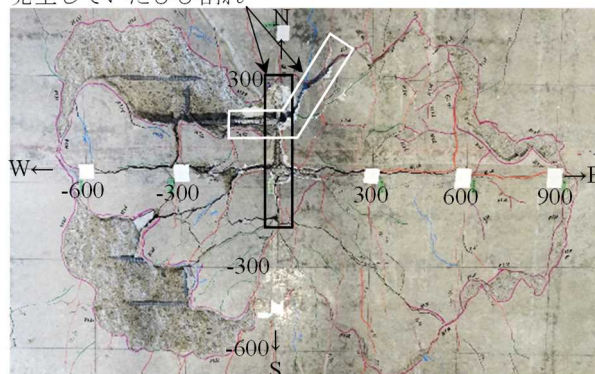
26万回以降、漏水が発生したひび割れ
